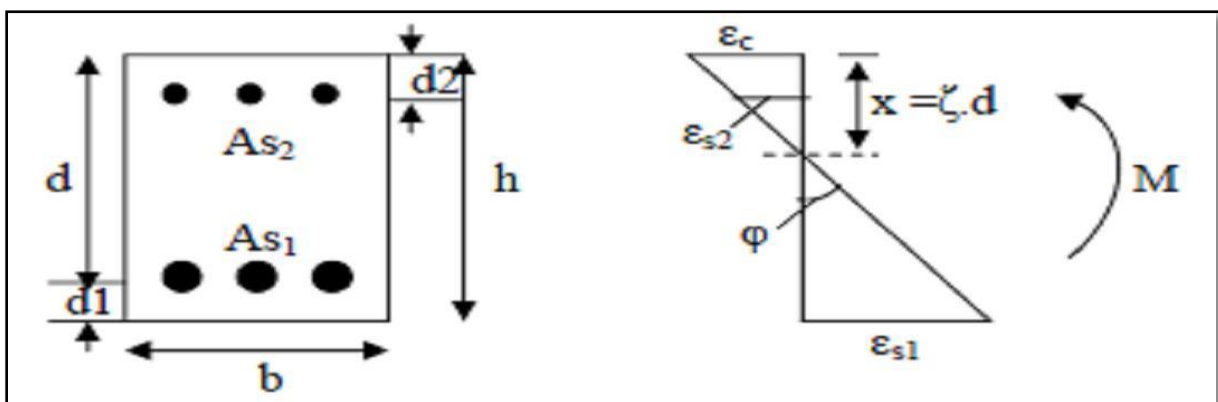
Courbure d'une section de poutre rectangulaire.
